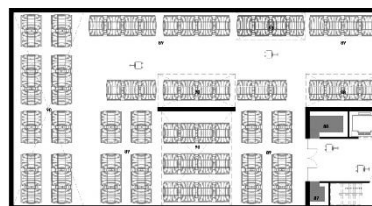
Planta de Distribución del Recinto - Segundo Sótano
